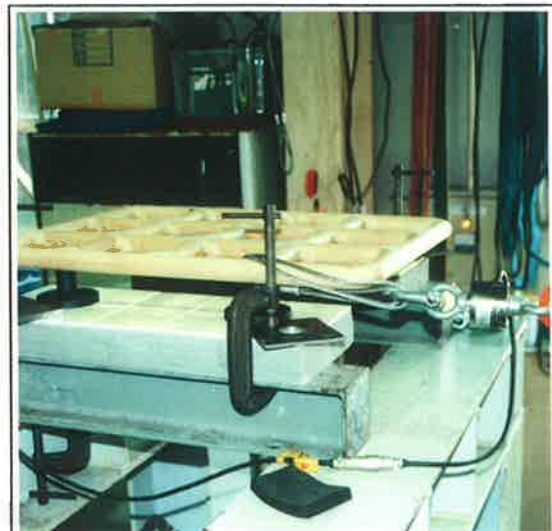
(l) 試験状況：鉛直P3(躯体:コンクリート)
